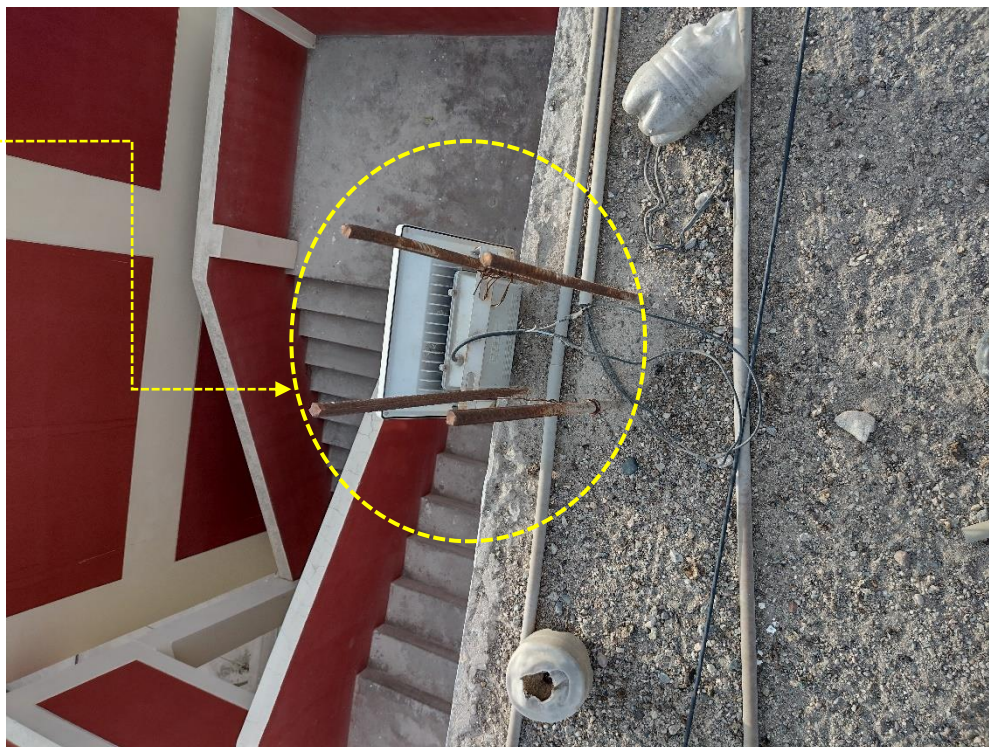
Arranque de acero interior en columna de pórtico Bloque 2
